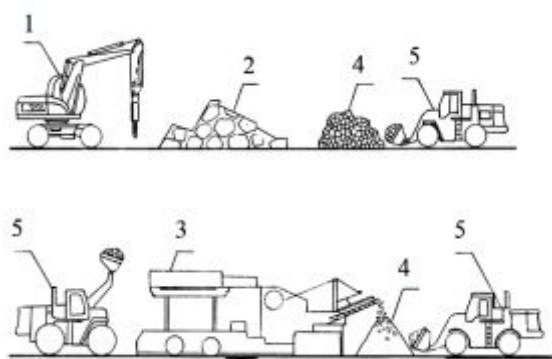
Технологічна схема рециклінгу брухту бетонних відходів: 1 – екскаватор з гідроножницями і гидромолотом; 2 – бетонний брухт; 3 – прилад для переробки; 4 – підготовлений матеріал; 5 – навантажувач.
